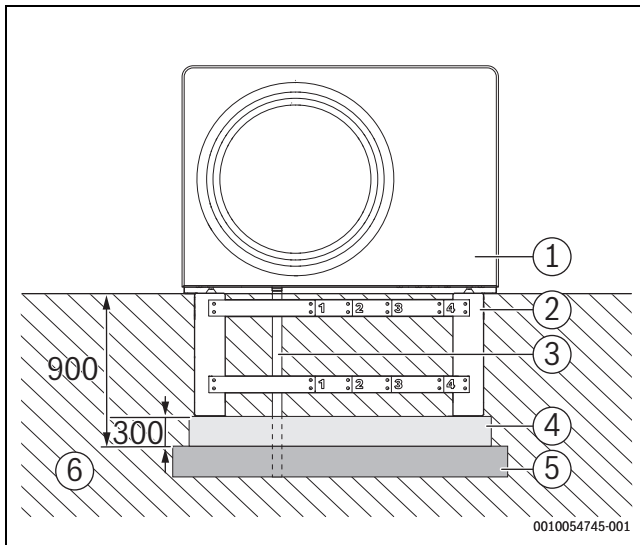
Exemple de mise en place : fondation préfabriquée dans le sol
